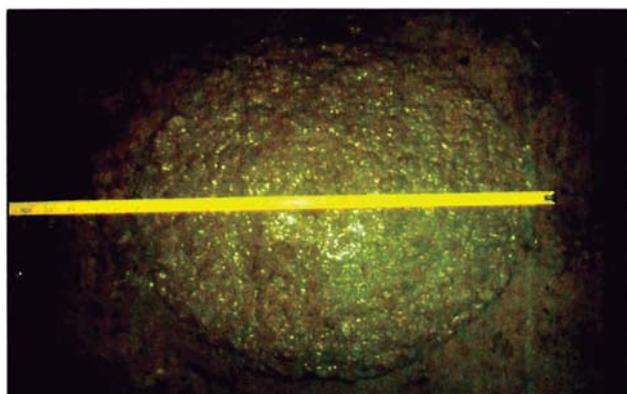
Ensayo de Extensibilidad en Concreto Auto-nivelante
